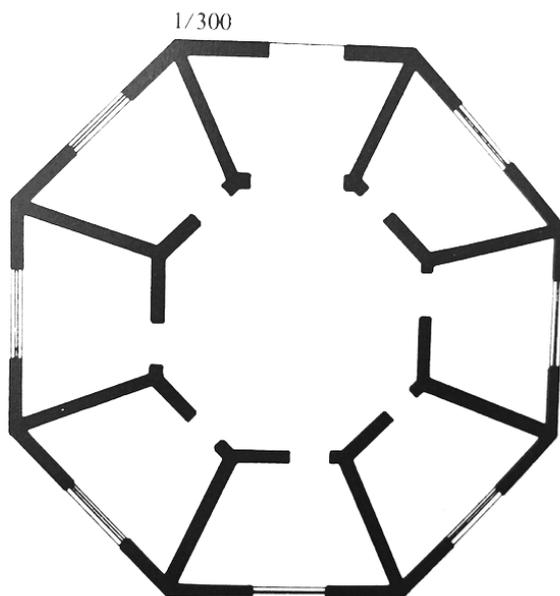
Planta baixa tombada. Fonte: MARANHÃO (1987).
